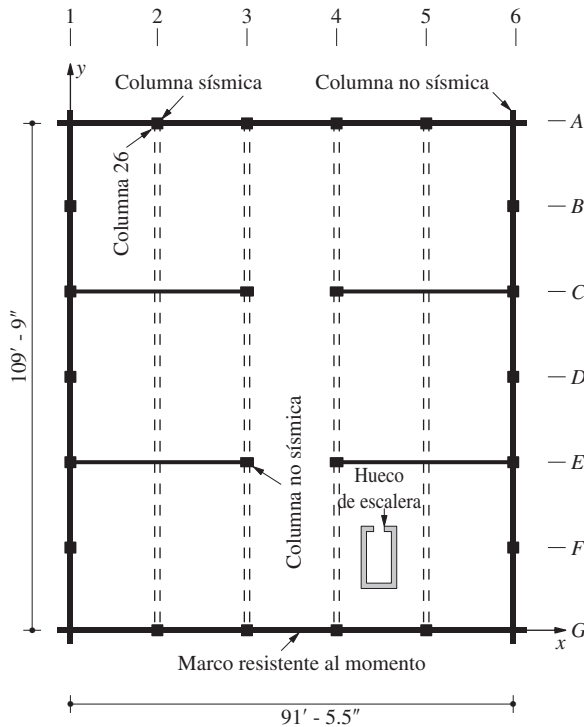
Planta estructural del edificio First Federal Savings.
